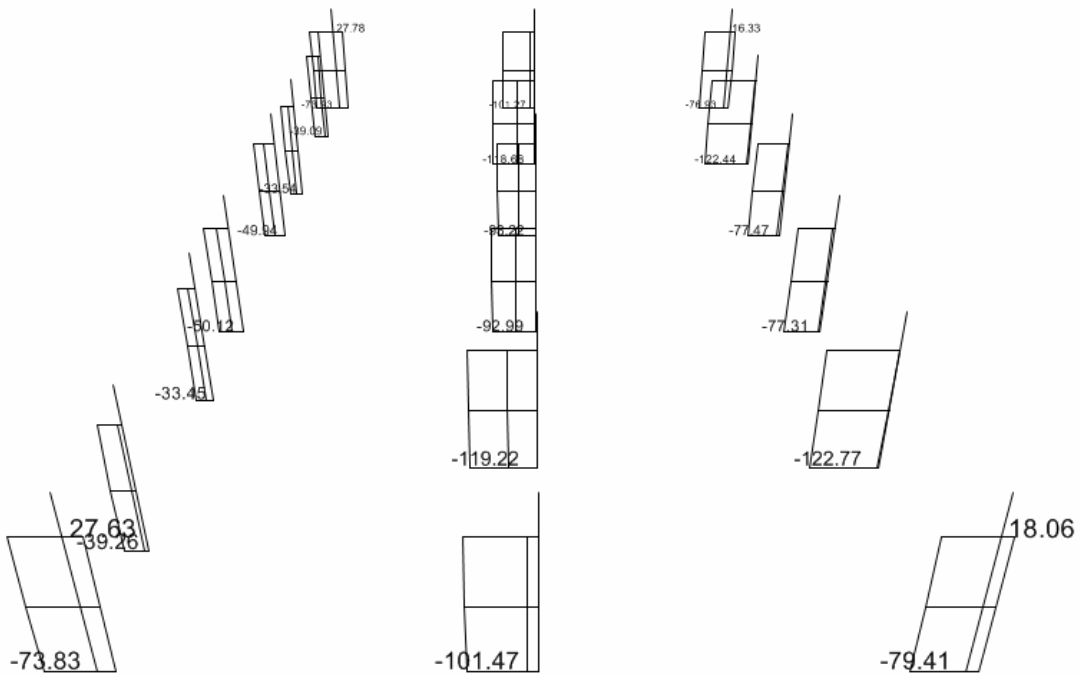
Se muestran las cargas axiales en la planta baja..
